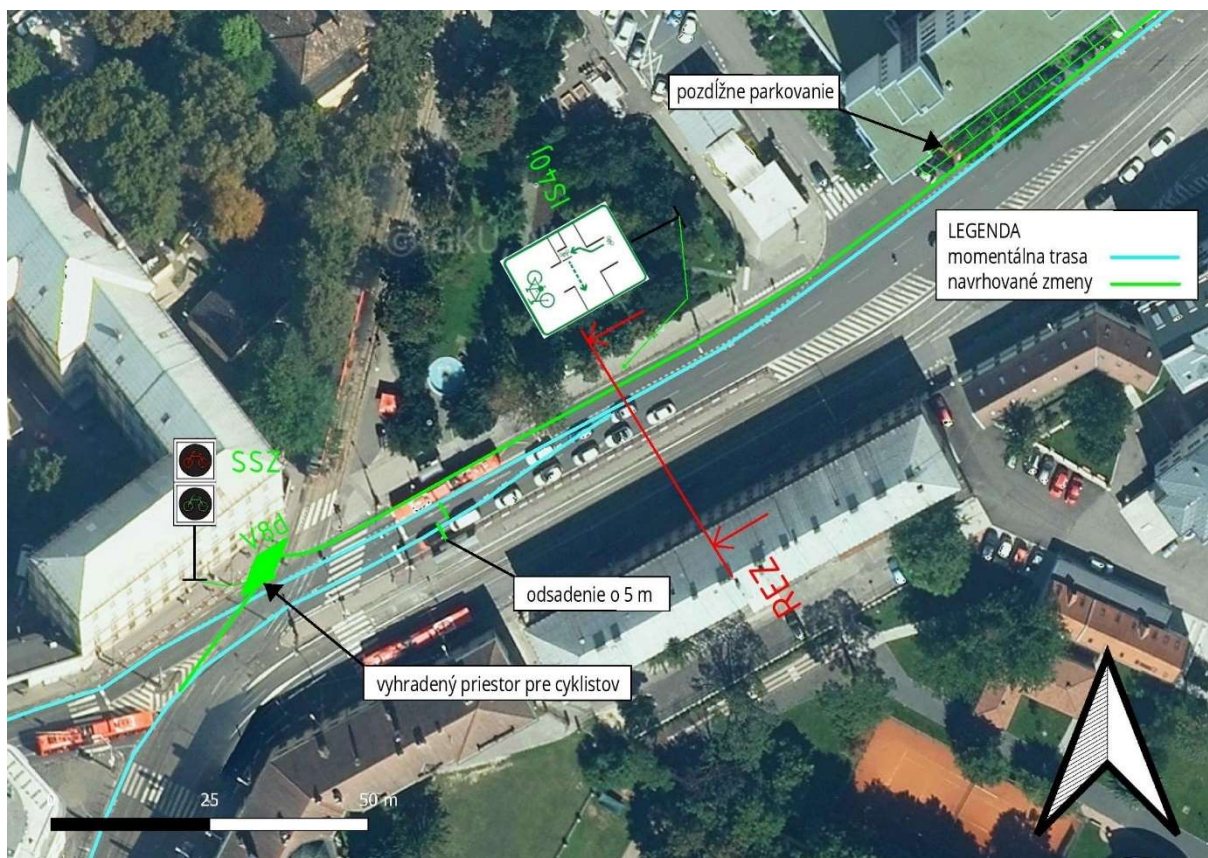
a [51], Obr. 88 b, Obr. 89 c; foto: autor
